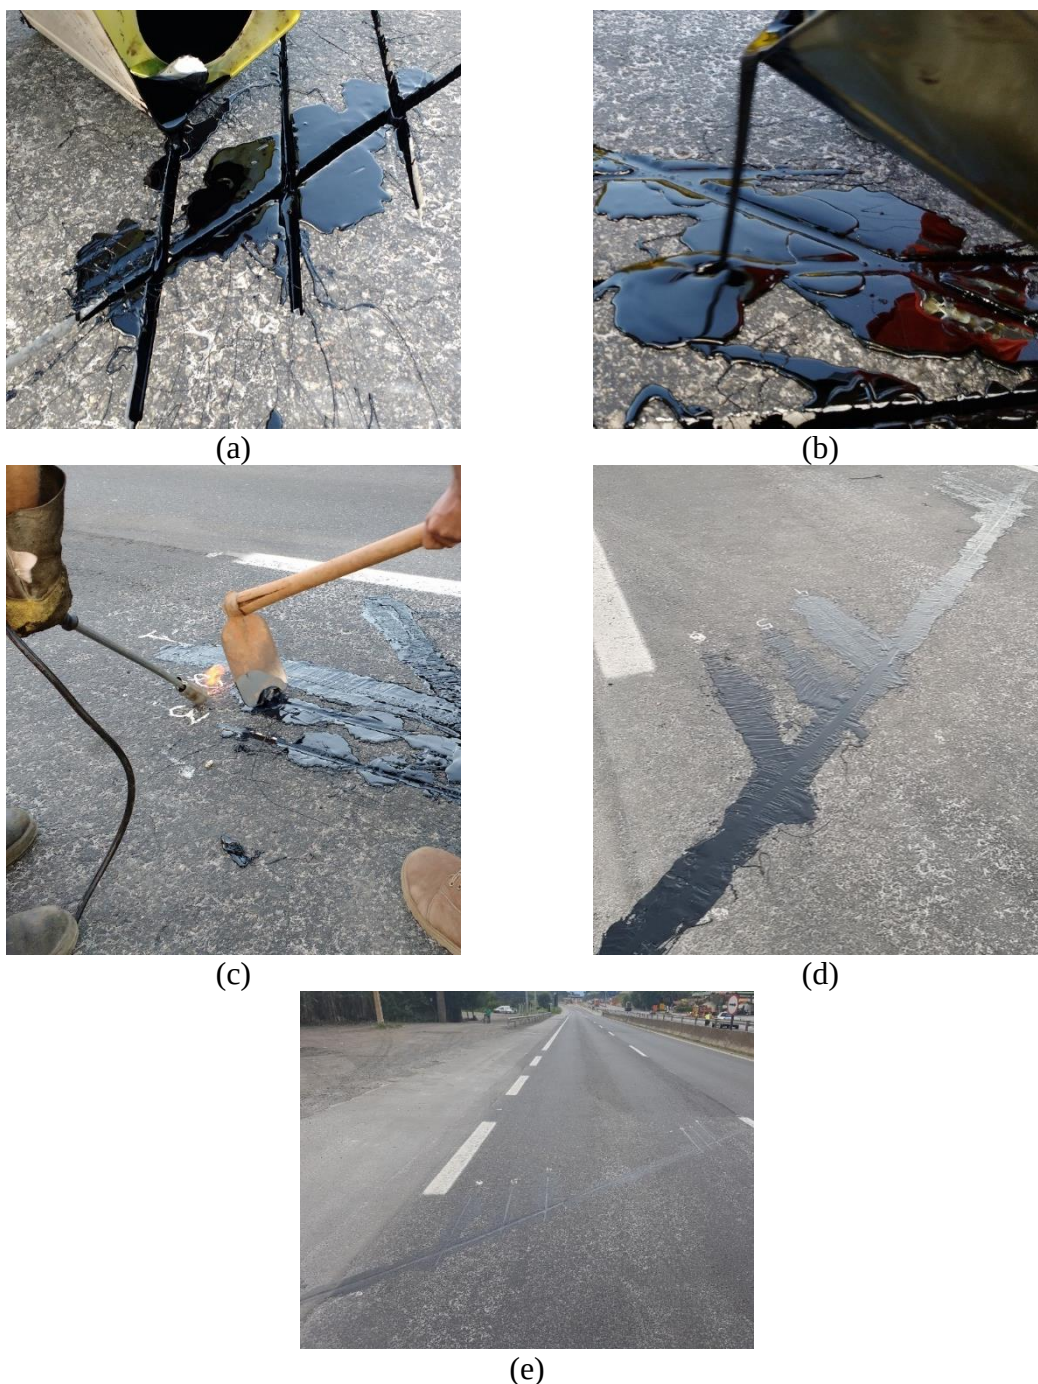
Fechamento dos cortes: (a) aplicação de CAP nos cortes do pavimento, (b) CAP derramado sobre a superfície do pavimento, (c) remoção do excesso de CAP com utilização de maçarico e enxada, (d) aparência do serviço após remoção do excesso de CAP da superfície do pavimento e (e) serviço finalizado
